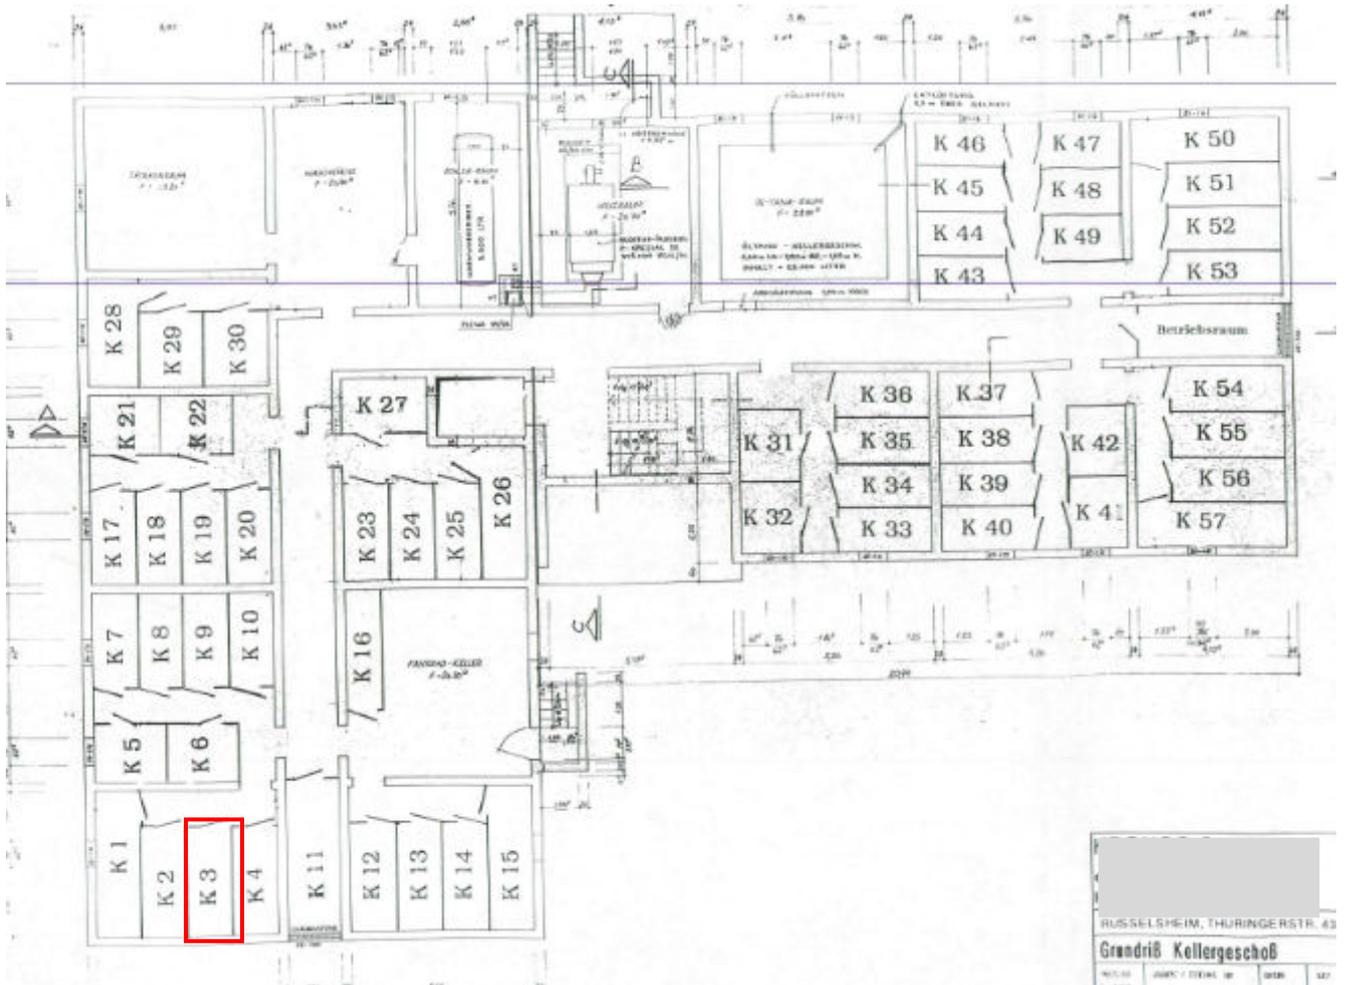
Grundriss KG (ohne Maßstab), Detail Kellerraum Nr. 3; Quelle: Bauakte, Abgeschlossenheitserklärung; Rotmarkierung und Anonymisierung d.d. SV
